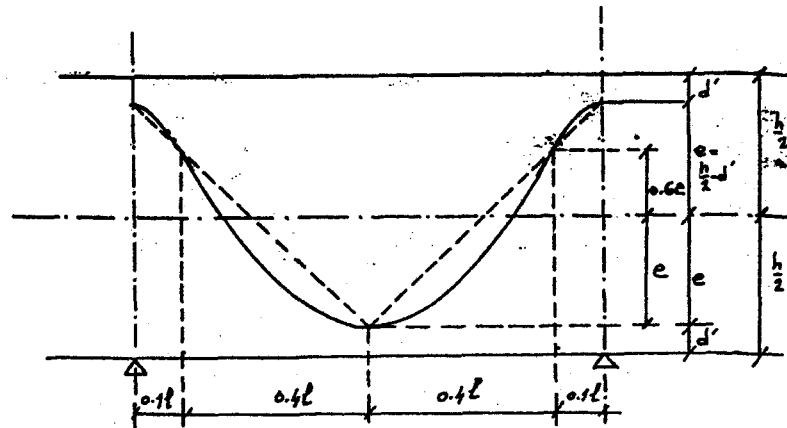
b. Travée intermédiaire — Tracé constructible du câble
